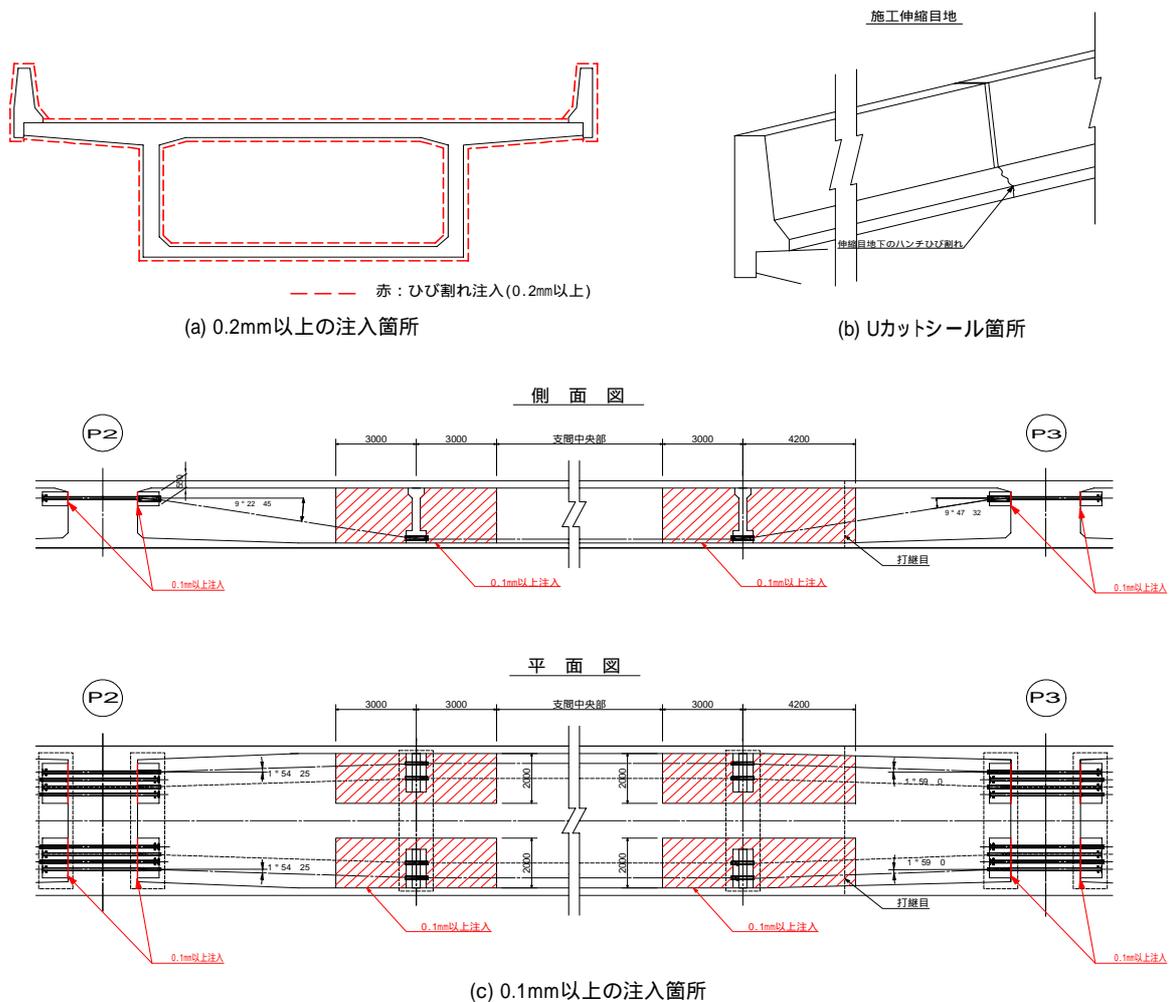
ひび割れ注入工法施工範囲
